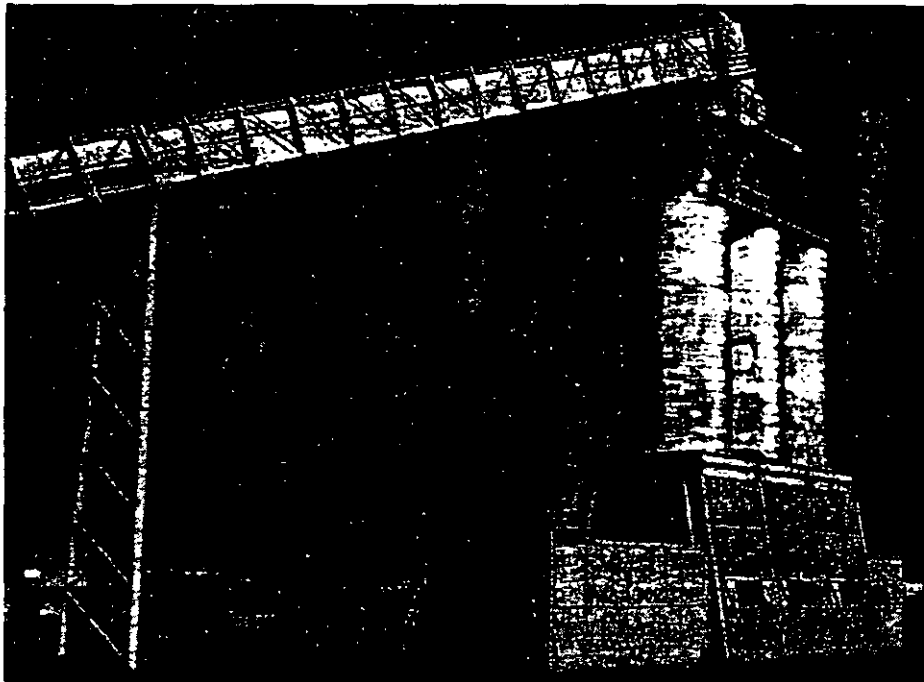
Silos Aislados de Almacenaje de Alta Capacidad para Concreto Asfáltico.
